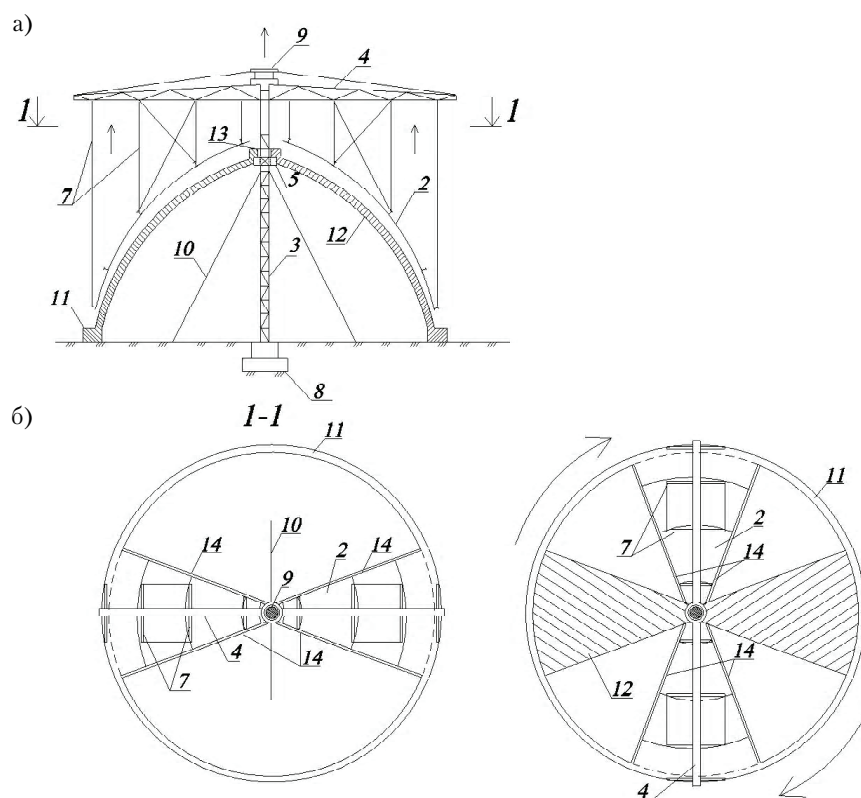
Раскружаливание опалубки купола: а) отрыв палубы от оболочки купола; б) поворот палубы на 90°; 2 – опалубка купола; 3 – временная опора; 4 – консольная стрела; 5 – неподвижное кольцо; 7 – связи; 8 – фундамент временной опоры; 9 – гидродомкрат; 10 – растяжки; 11 – нижнее опорное кольцо; 12 – оболочка купола; 13 – верхнее опорное кольцо; 14 – ограничительные бортики.
